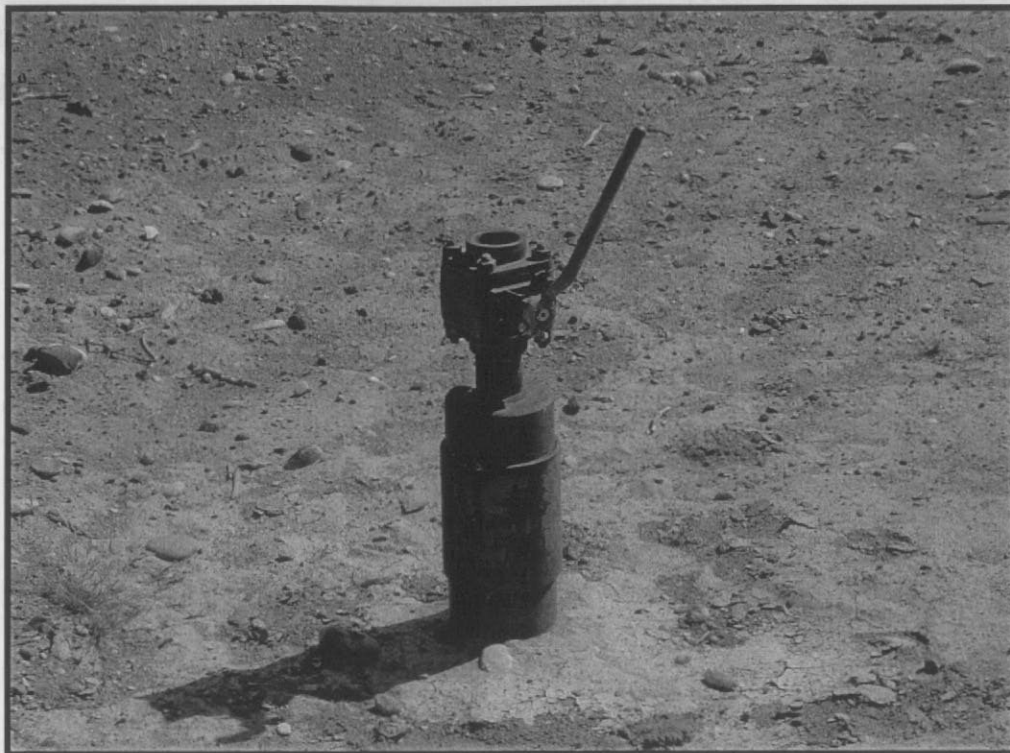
Pozo LP-1325 (E) Coordenadas X: 2608088 Y: 5796495
